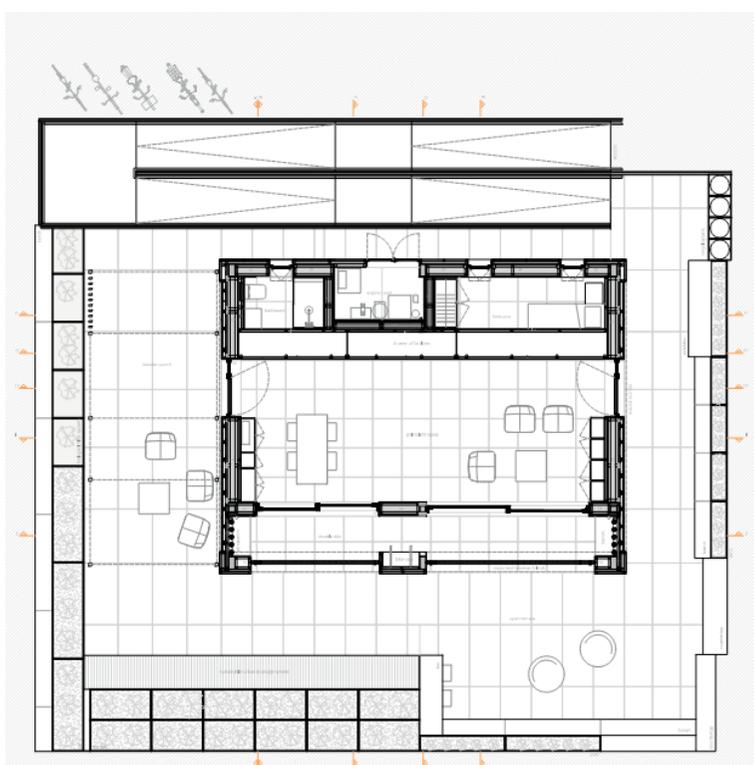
Plano de la planta del proyecto. Fuente: Azalea.
